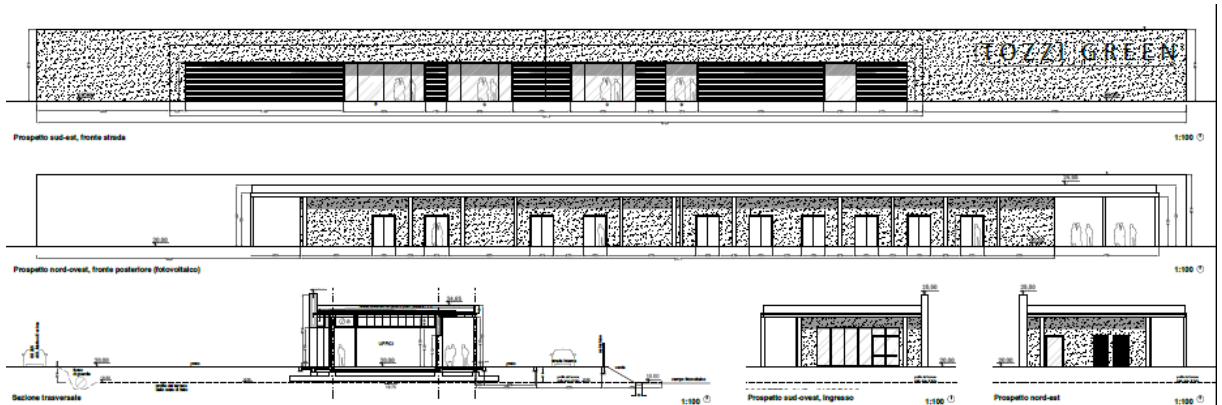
Prospetto Hub di ricerca – Estratto TAV 3.0
